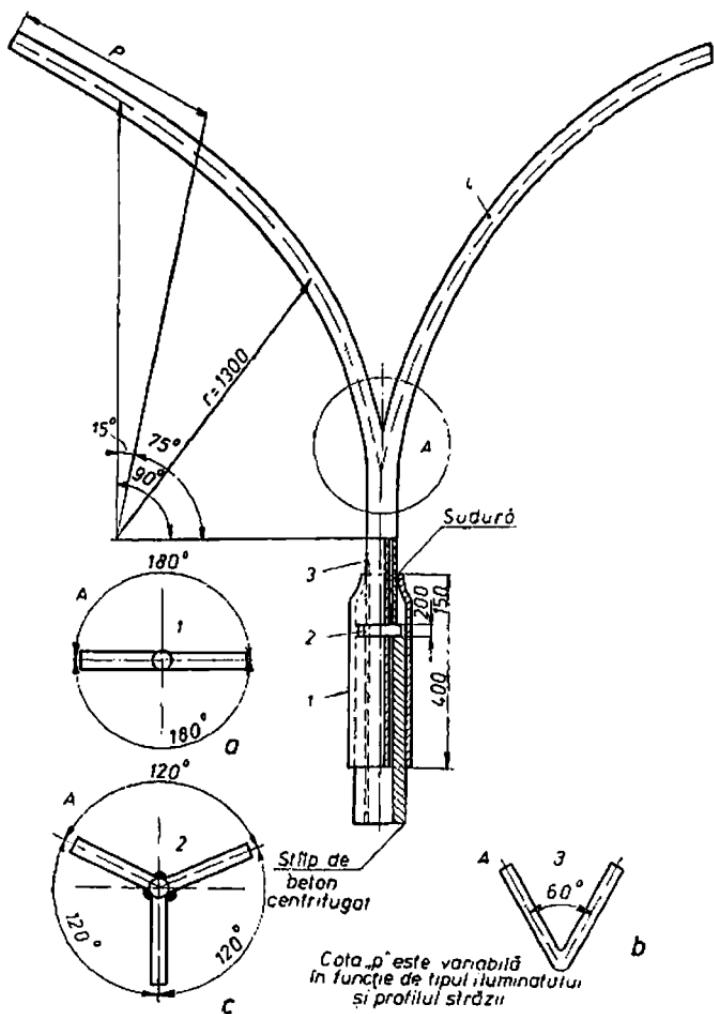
Prelungire din ţeavă cu una, două, sau trei braţe, pe stilpi din beton:
